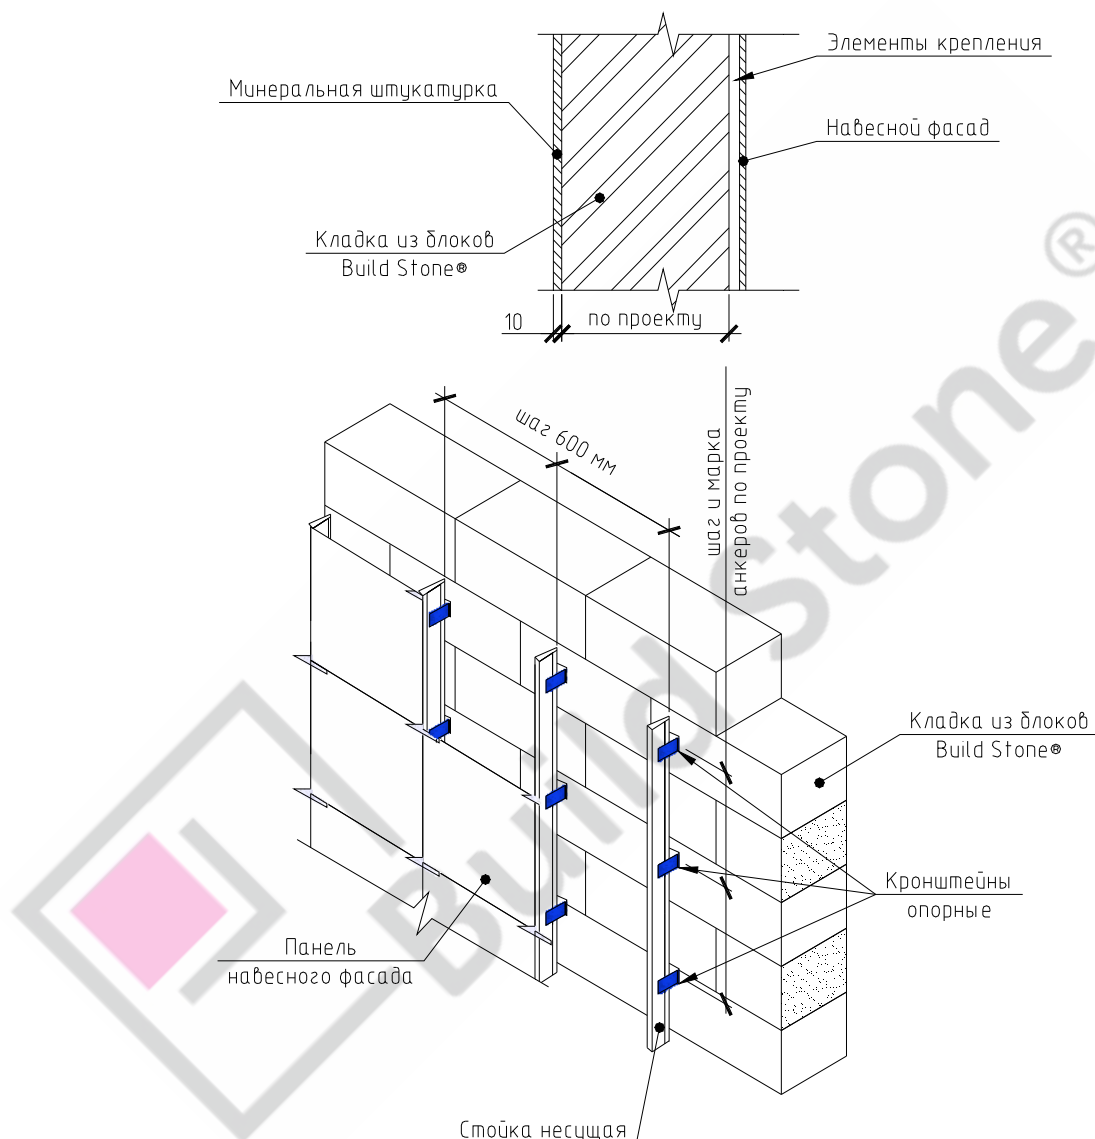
Стена с внутренней штукатуркой и облицовкой гранитом
